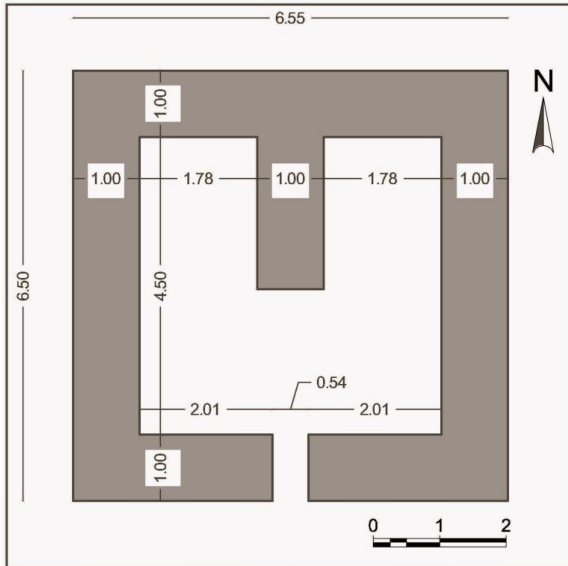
أطم (حصن) الخشاشة: مسقط أفقي
